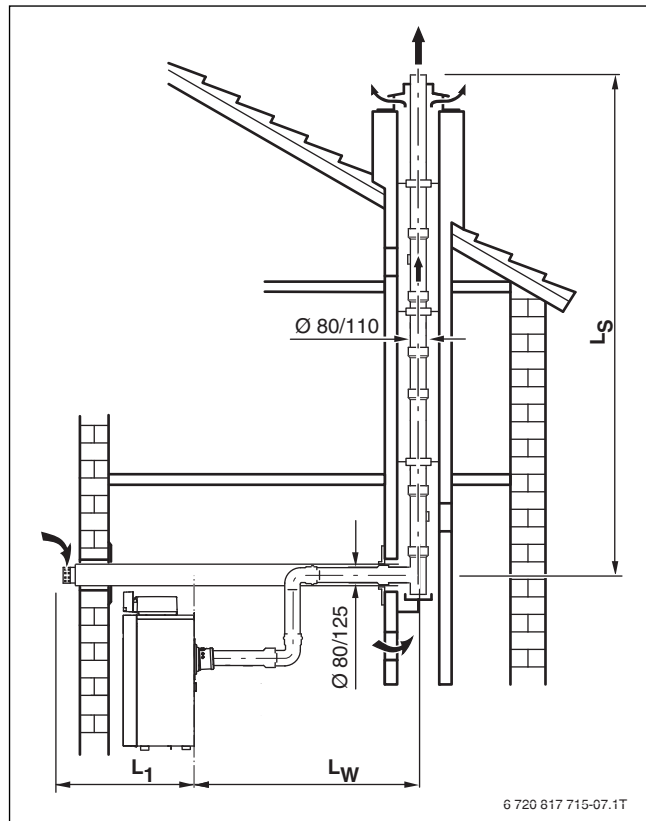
Conducto separado en caja de chimenea, rígido ( $C_{53(x)}$ )
